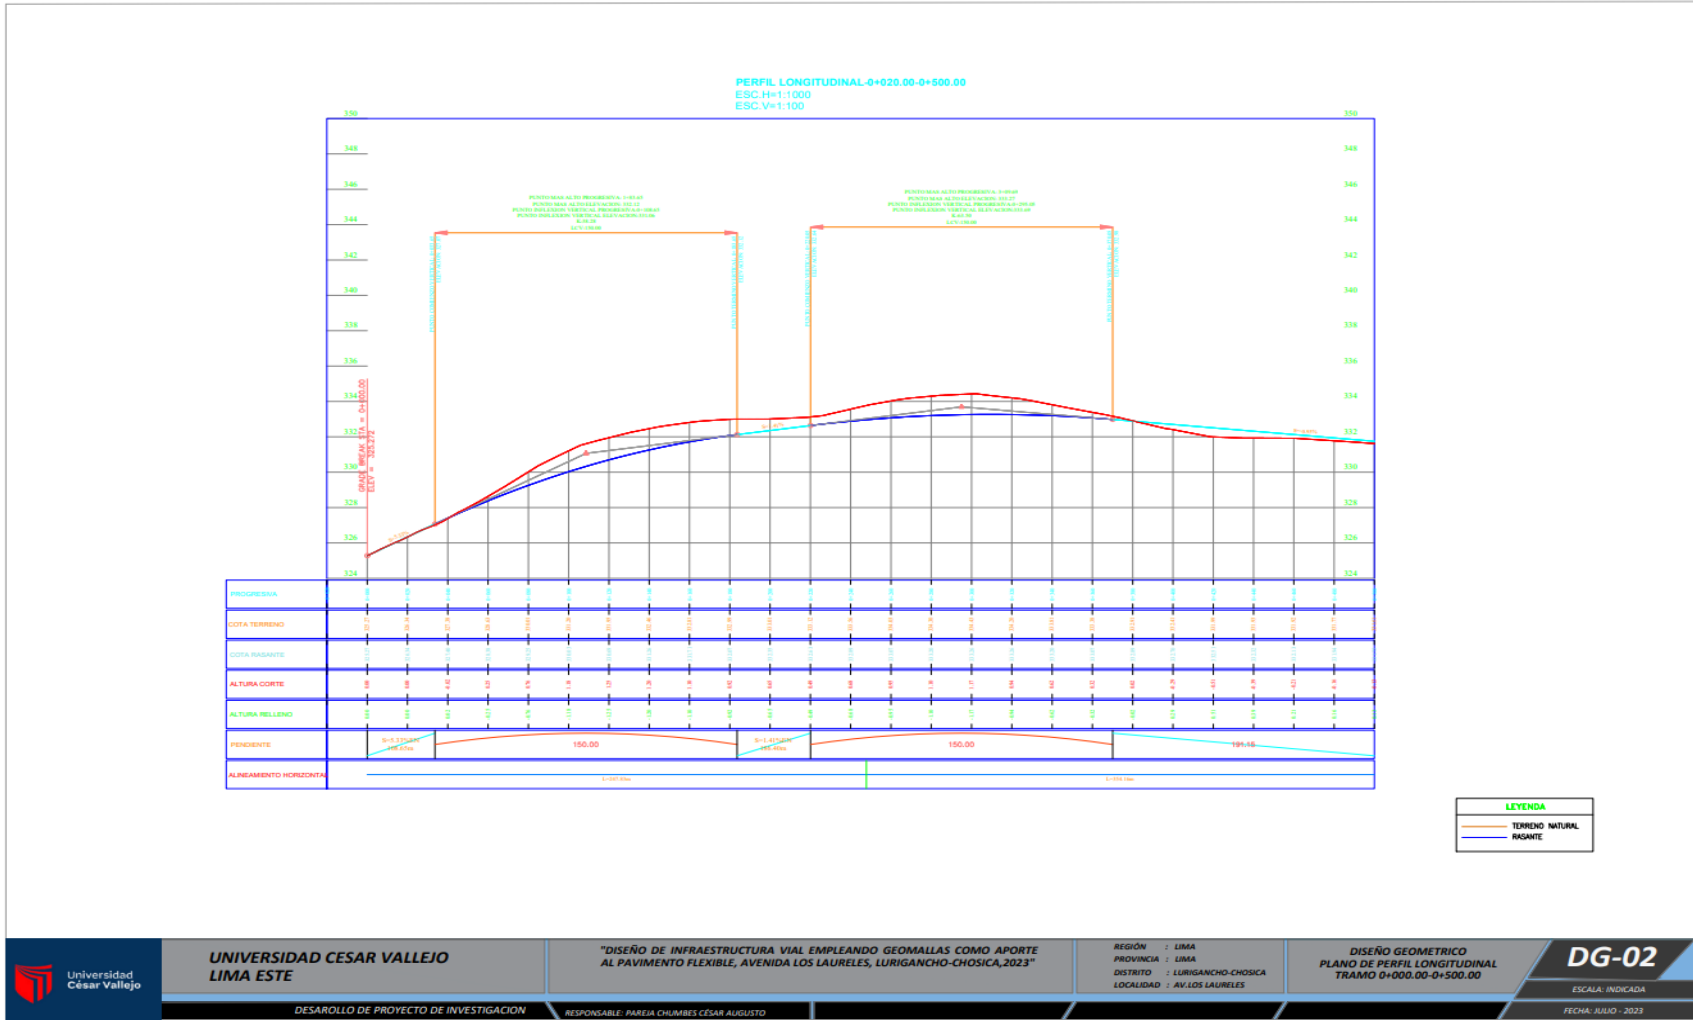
Perfil longitudinal-Av. Los Laureles
